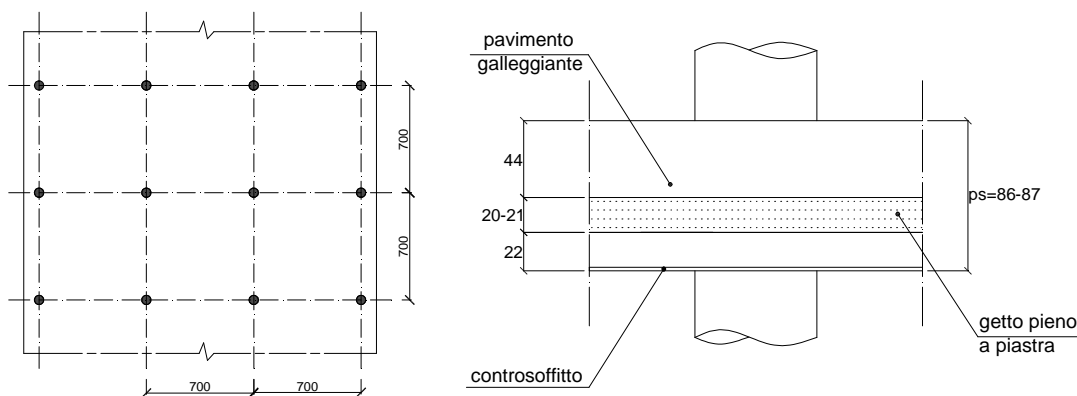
soluzione n.°1 in NSC, pianta di piano e sezione impalcato
